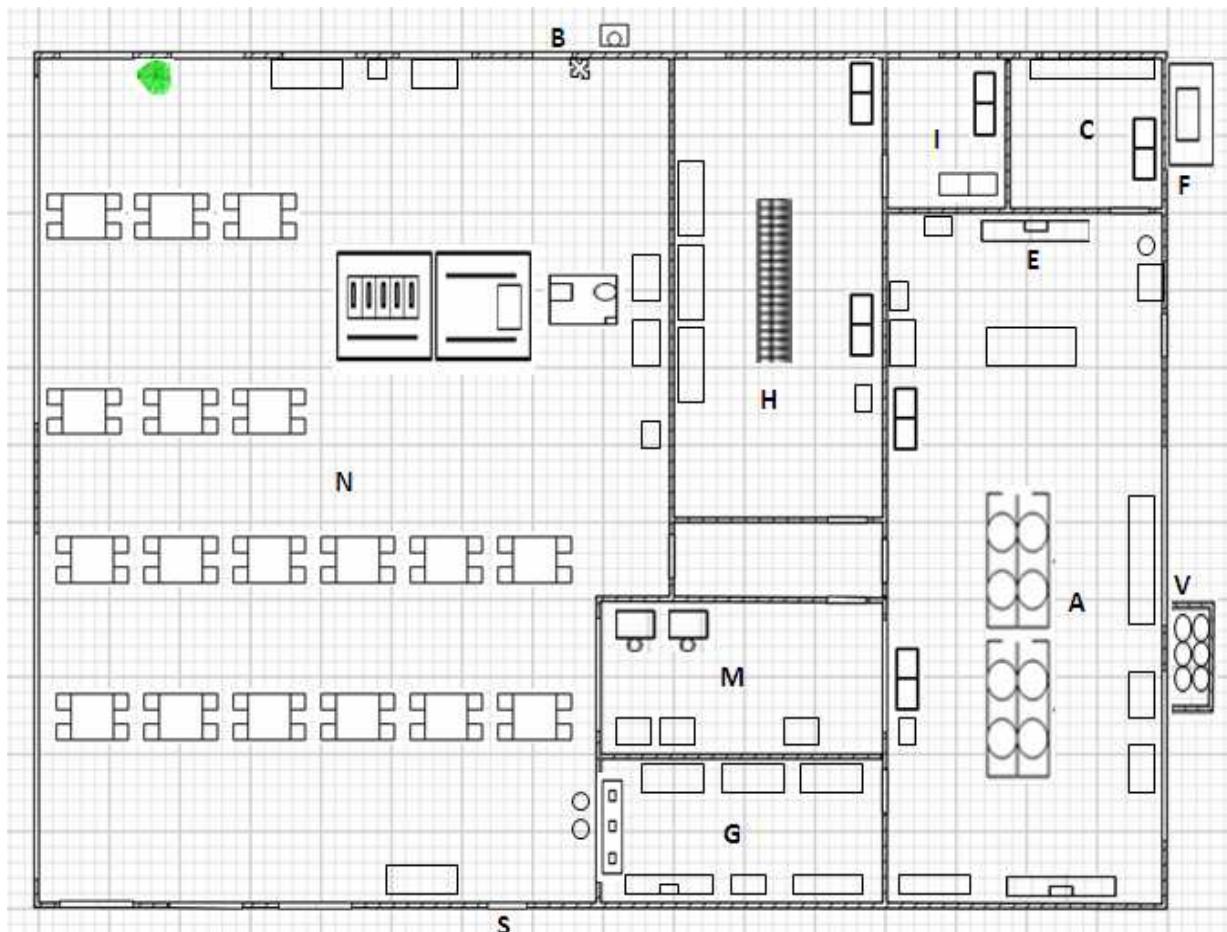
Planta Baixa do Restaurante Industrial (UAN 2)
